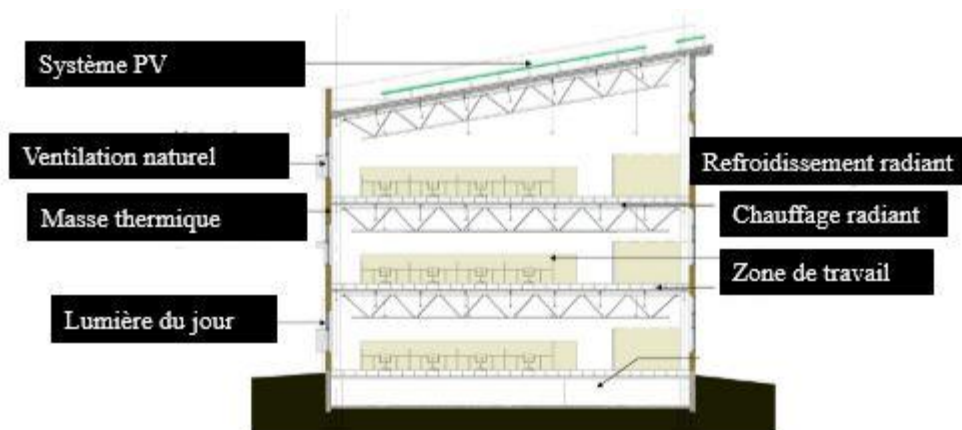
Coupe verticale du bâtiment administratif (Source : ArchDaily.com)
